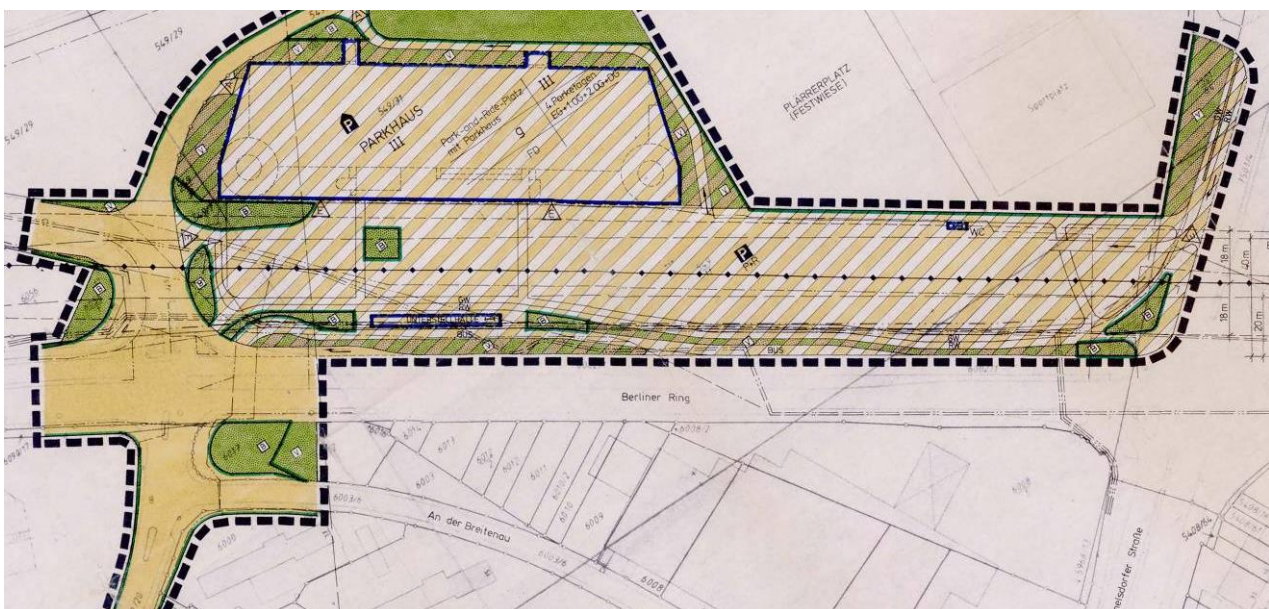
Ausschnitt – Bebauungsplan Nr. K 3 A (Park- and Ride-Platz an der Breitenau), 1997
